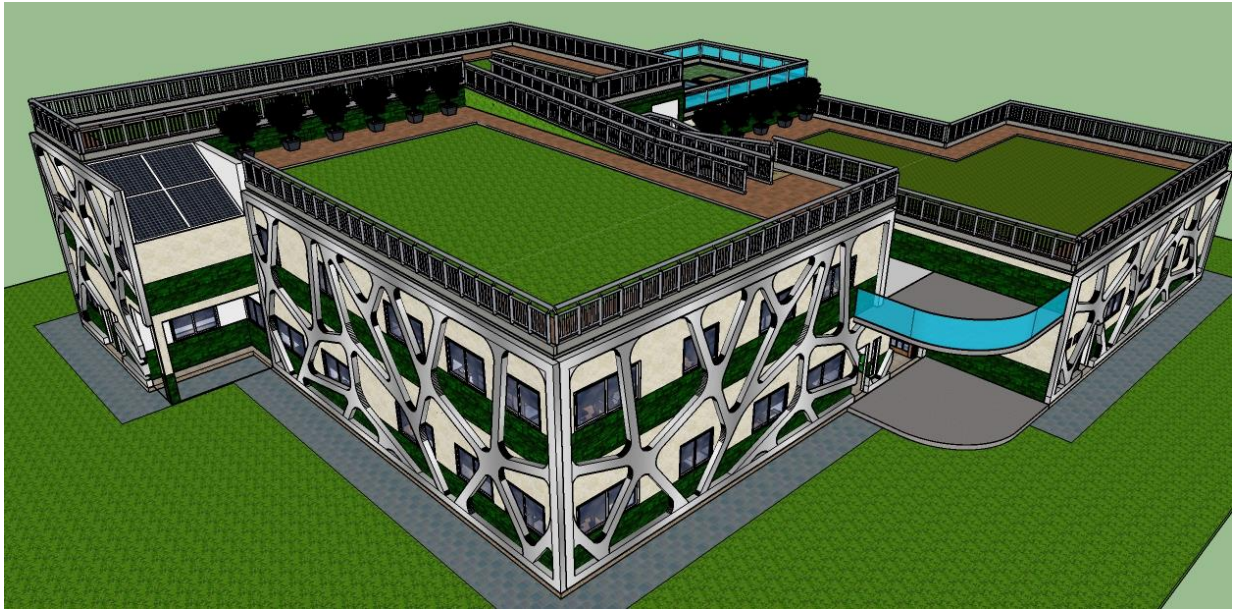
Fachada lateral 1. Fuente: Elaboración propia del autor.
